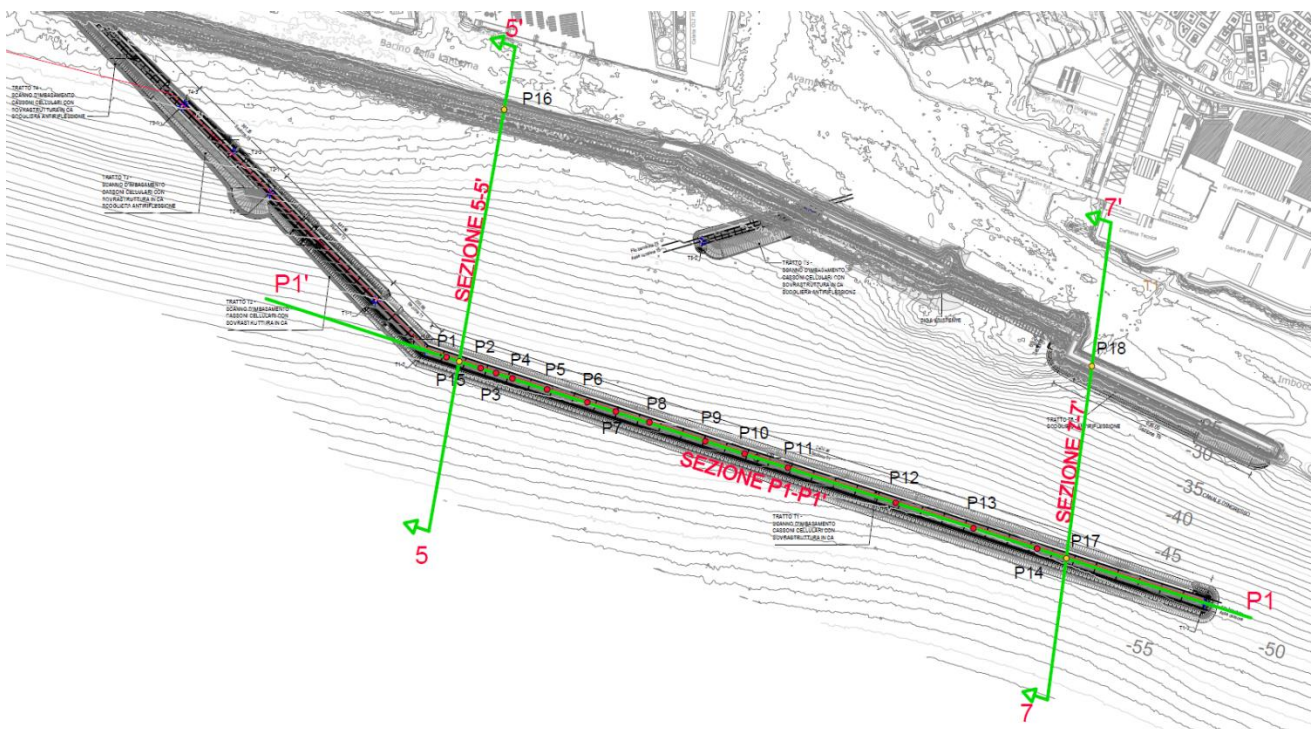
Traccia planimetrica delle sezioni di calcolo P1-P1', 5-5' e 7-7'
